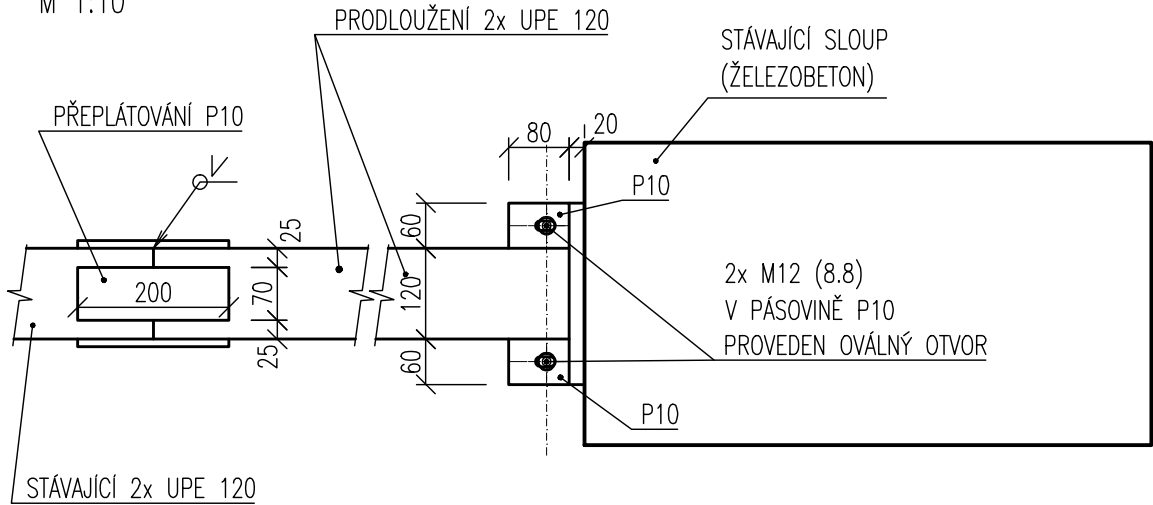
PŘIPOJENÍ NOSNÍKŮ K BETONOVÝM SLOUPŮM
